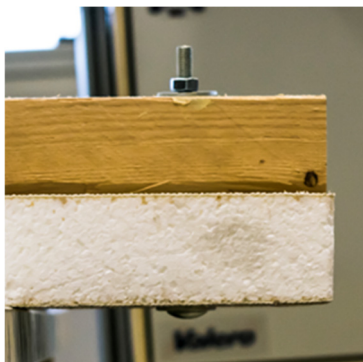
Panel fijado mediante tornillo pasante a viga de madera
